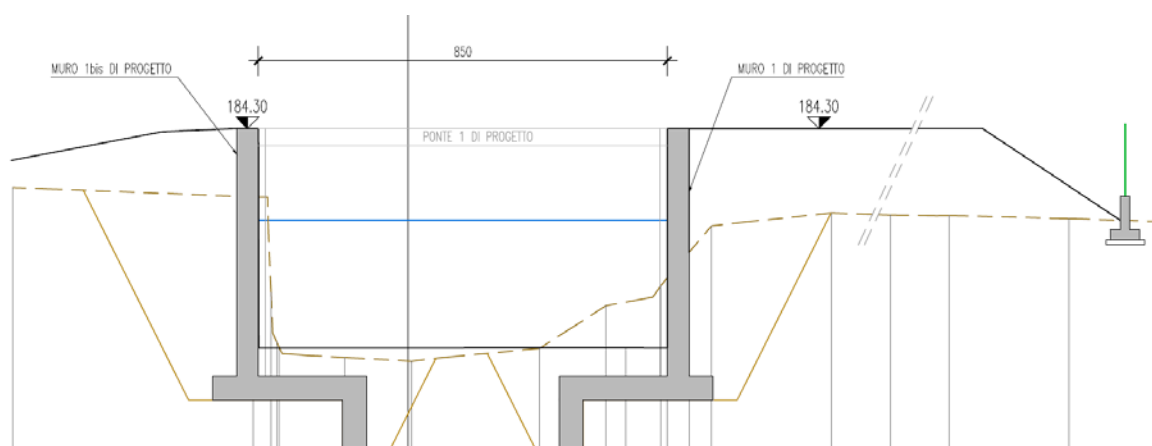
Estratto Tavola 07 – sezione del ponte 1 privato
